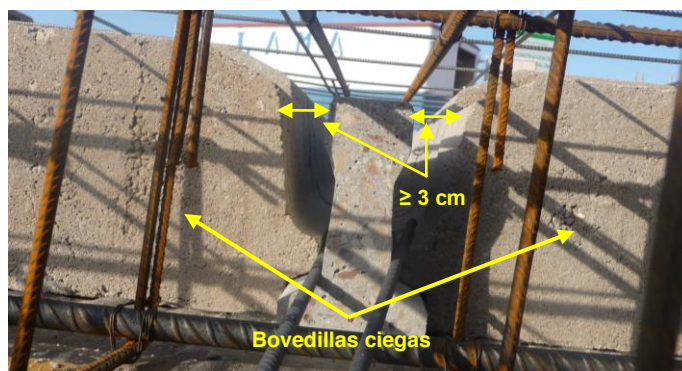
y 7. Compatibilidad entre viguetas pretensadas y bovedillas de hormigón
